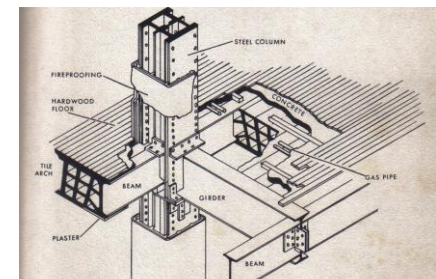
Detalhe construtivo projeto do *Second Leiter Building
